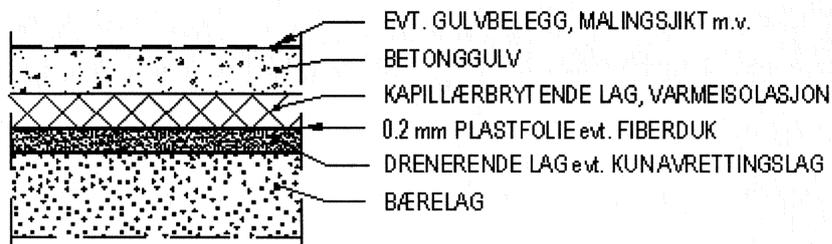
a: Betonggulv med underliggende lastbærende varmeisoleringslag på grunnen
